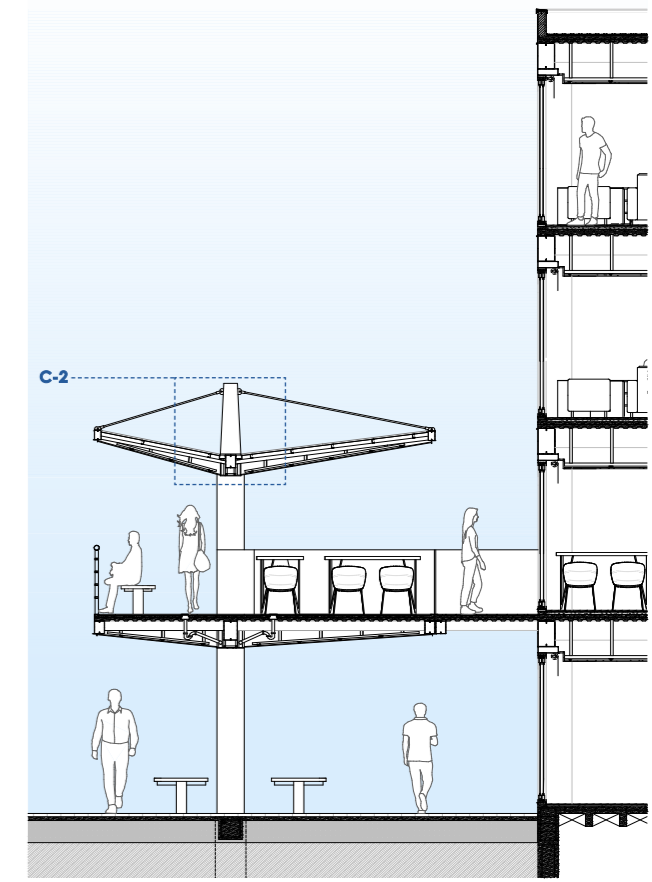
Sección Constructiva S-1-Detalle C-2. Fuente: Elaboración propia (2026)
